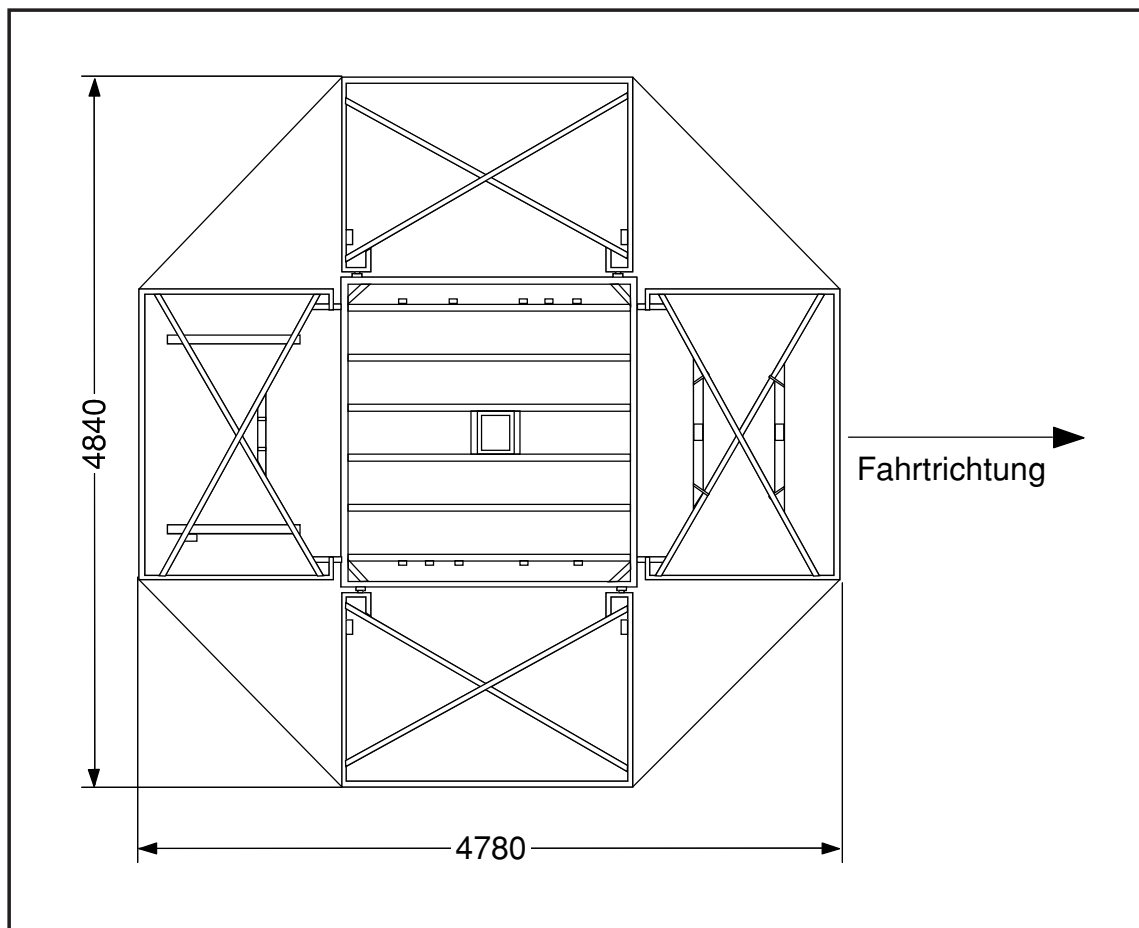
Abmessungen der Dachkonstruktion, Arbeitsstellung
